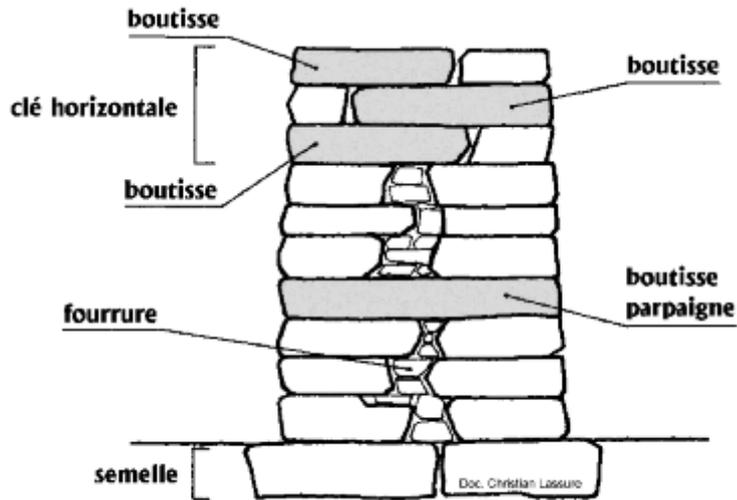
coupe transversale type d'un mur de soutènement en maçonnerie
